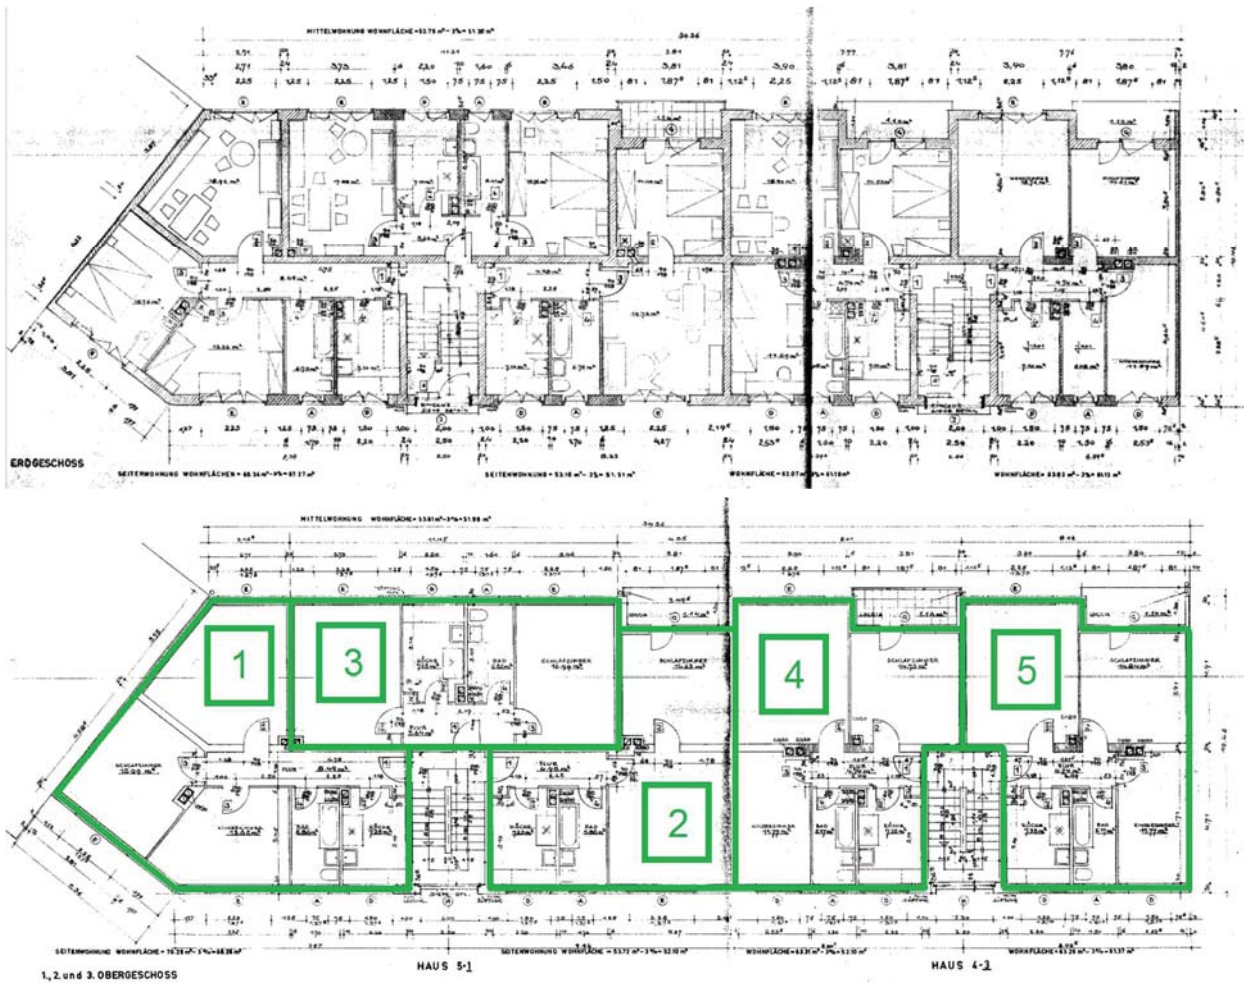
Grundriss des EG der Mehrfamilienhäuser 1 und 3 und Bezeichnung der Wohnungen
